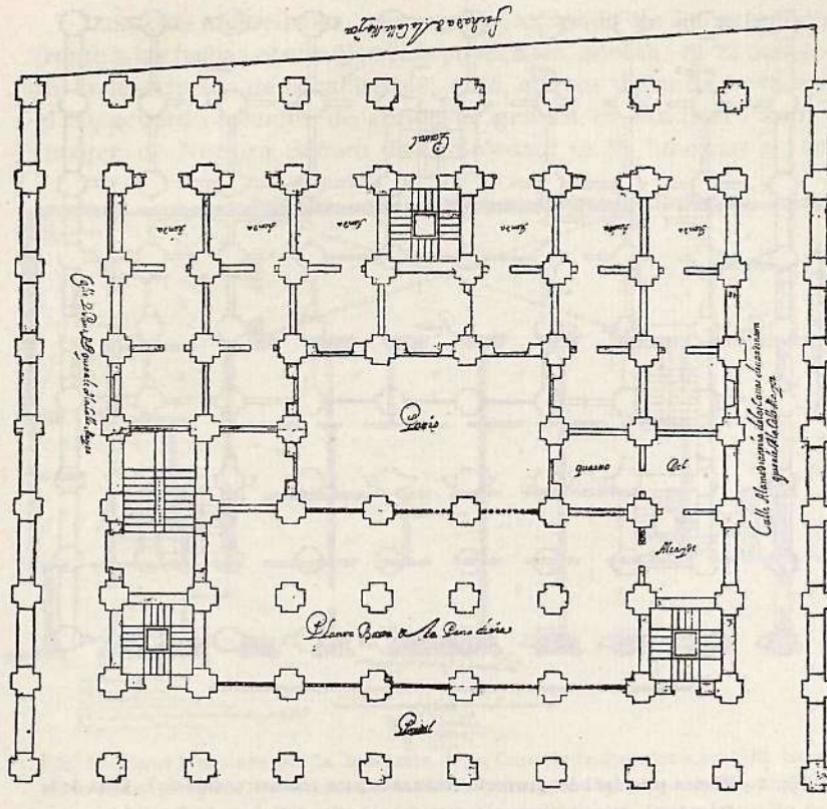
Planta baja de la Casa de la Panadería, según el proyecto presentado en 1672 por Juan García de Gonzalo, que fué rechazado.
